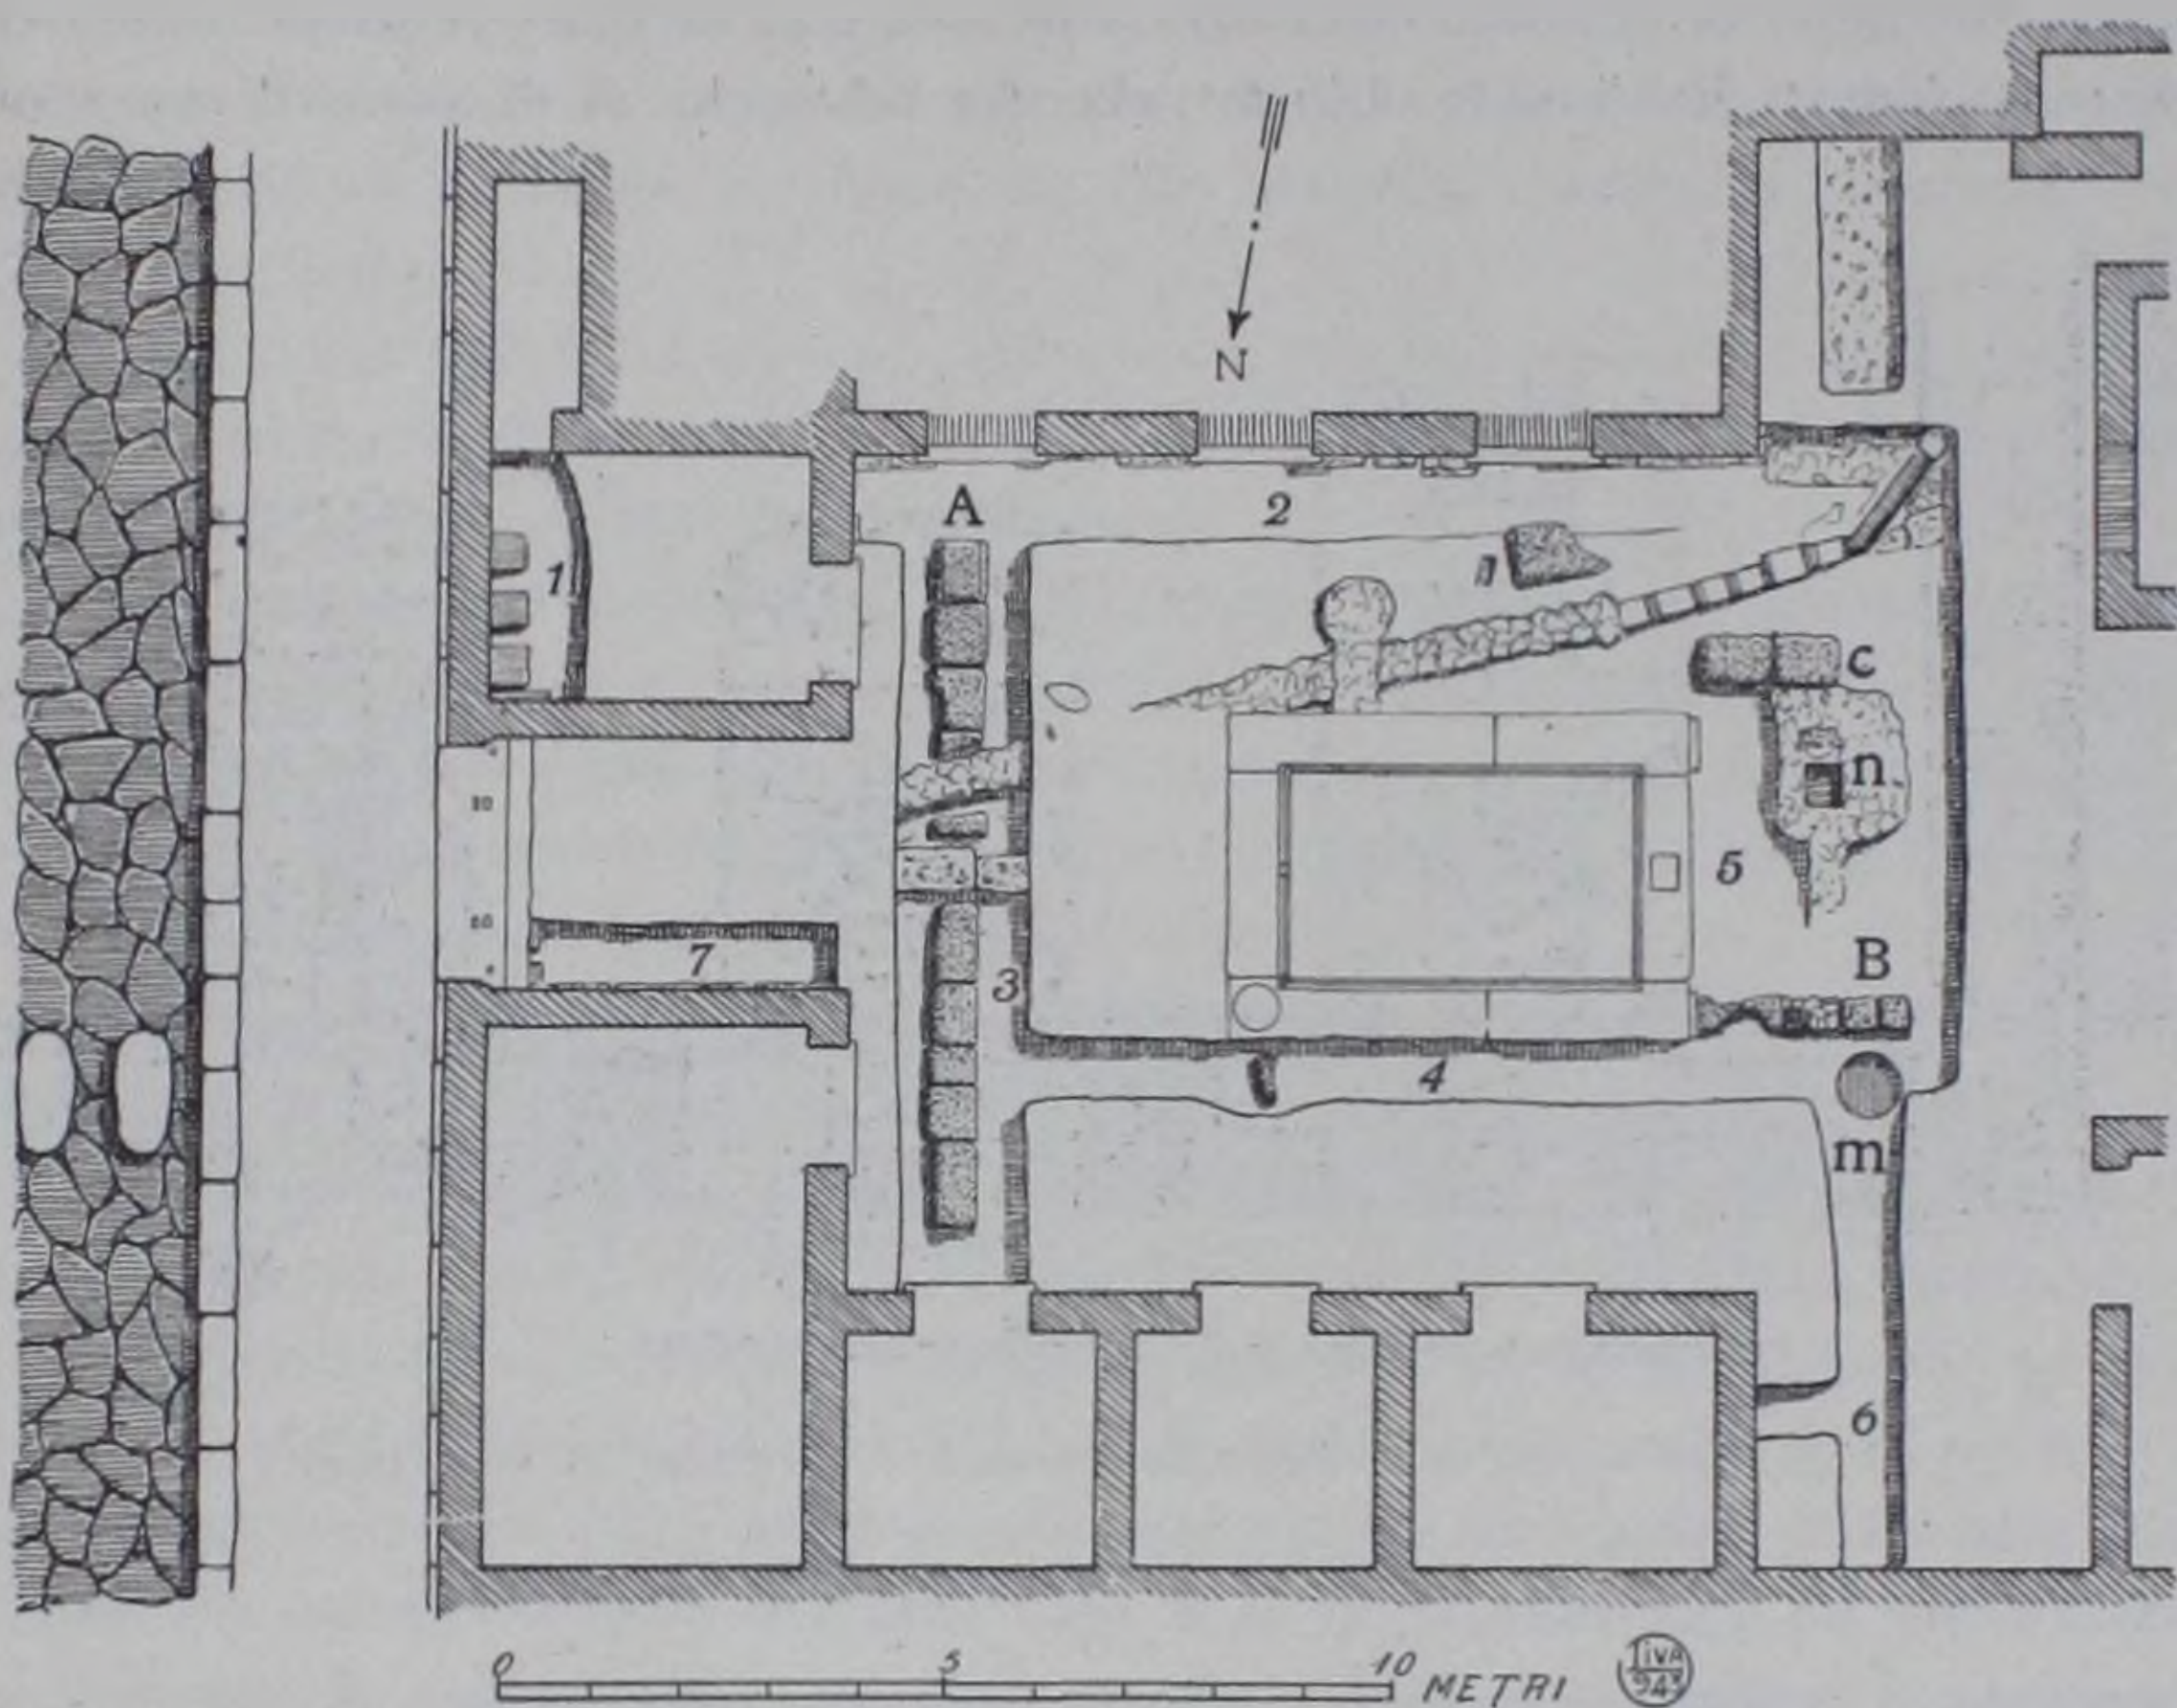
«Casa della Fontana grande». — Planimetria.
